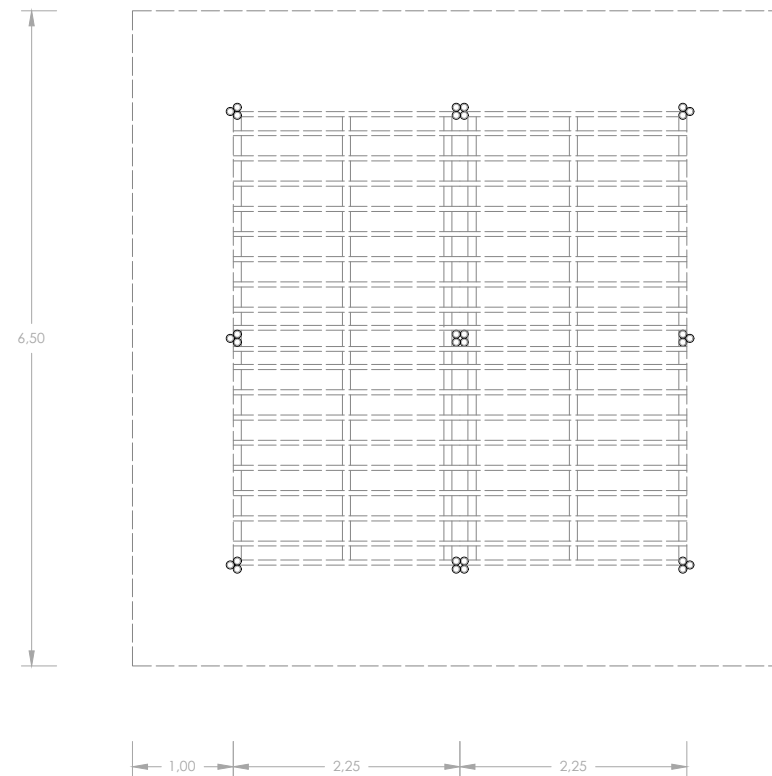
Planta de estructura de forjado. e: 1/75
